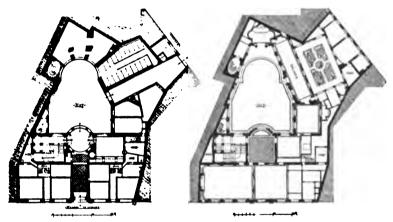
und 42. Hôtel de Beauvais zu Paris. Grundriss des Erd- und des Hauptgeschosses.
